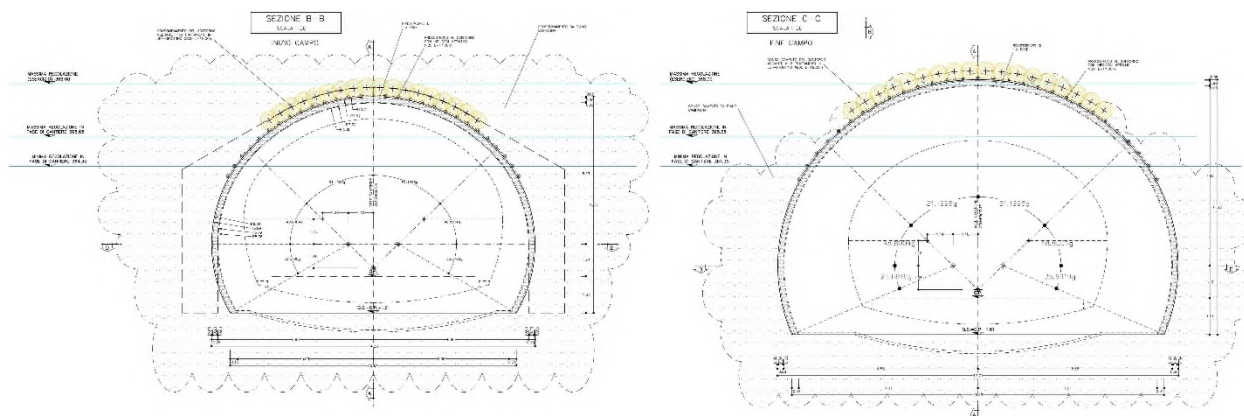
Sezione Camerone Convergente (campo iniziale) – Scavi e consolidamenti - Sezione
